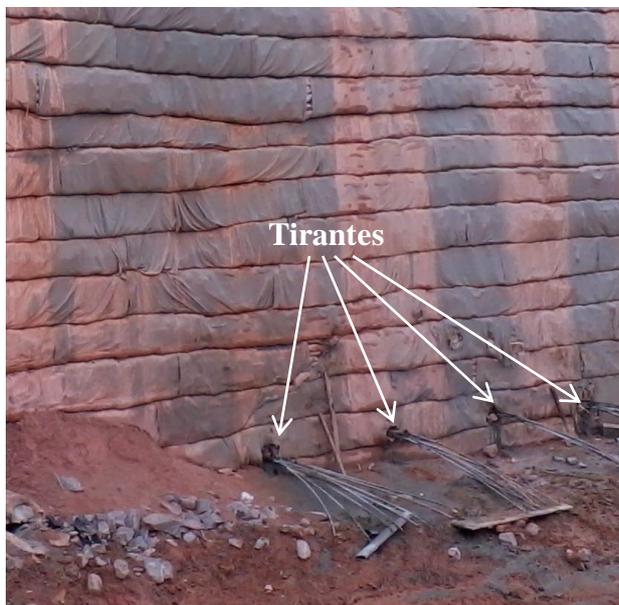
1º linha de tirantes do Muro 03, detalhe da face envelopada.
